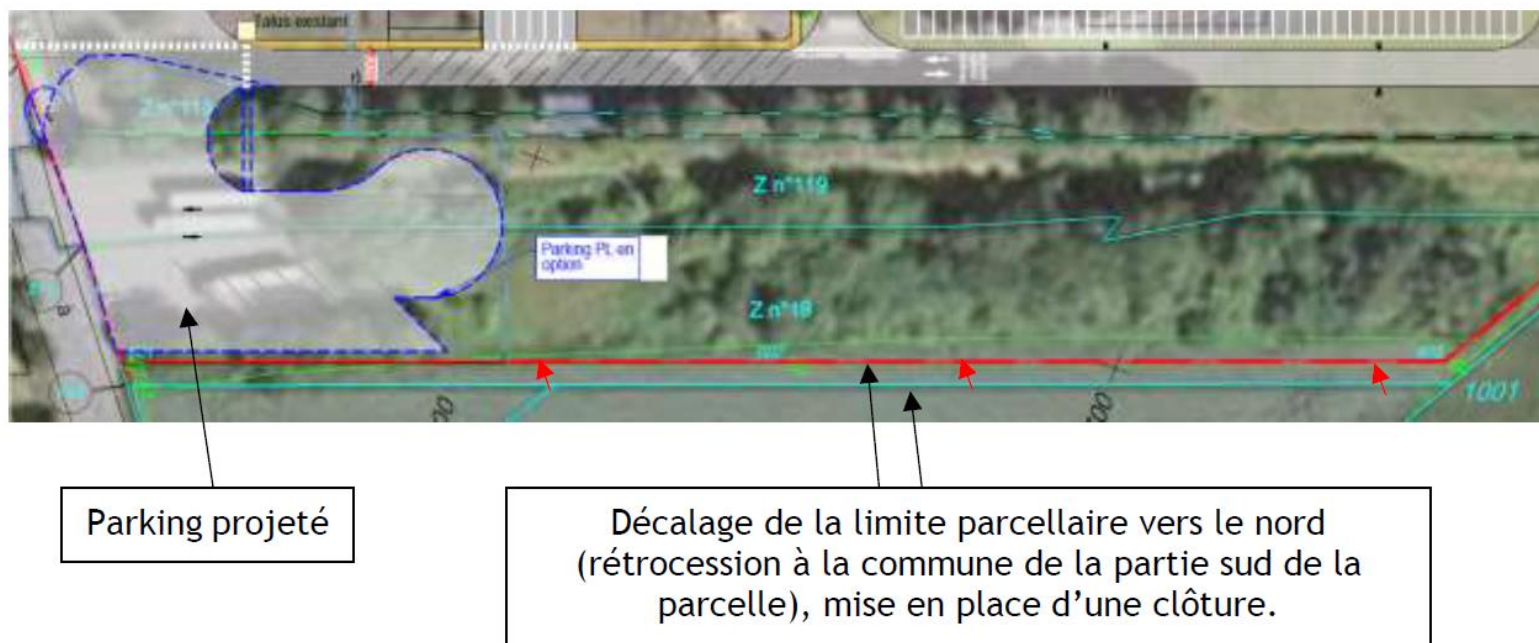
décalage de la limite parcellaire sud du site, vers le nord (D'après plan Aconstruct)
